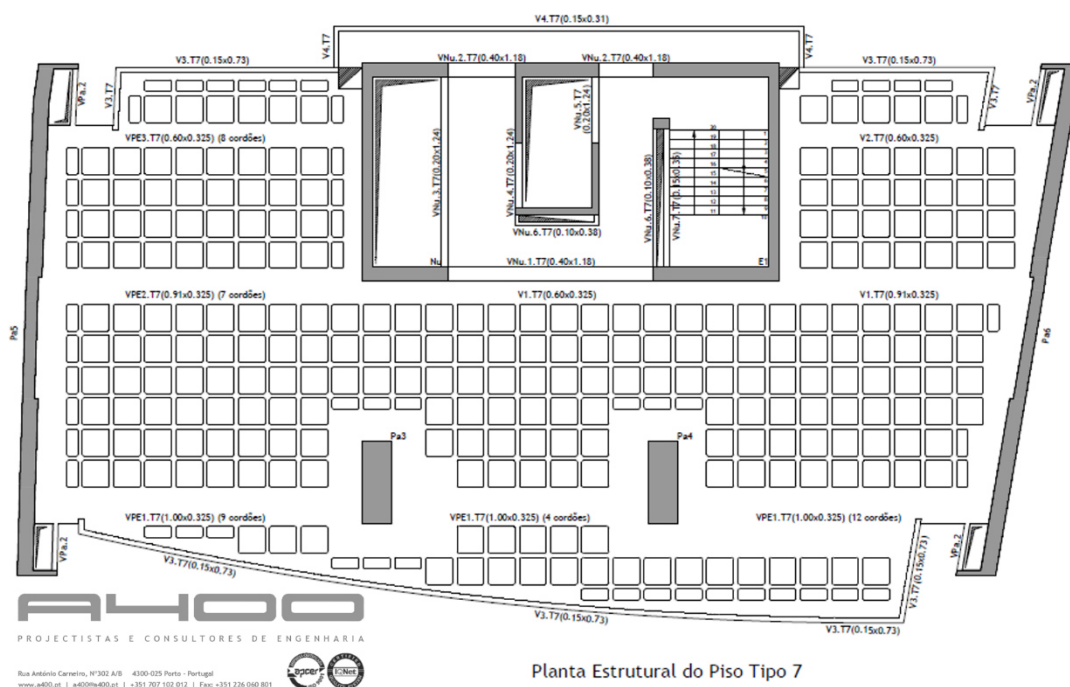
Planta estrutural do piso tipo 7 do caso de estudo
